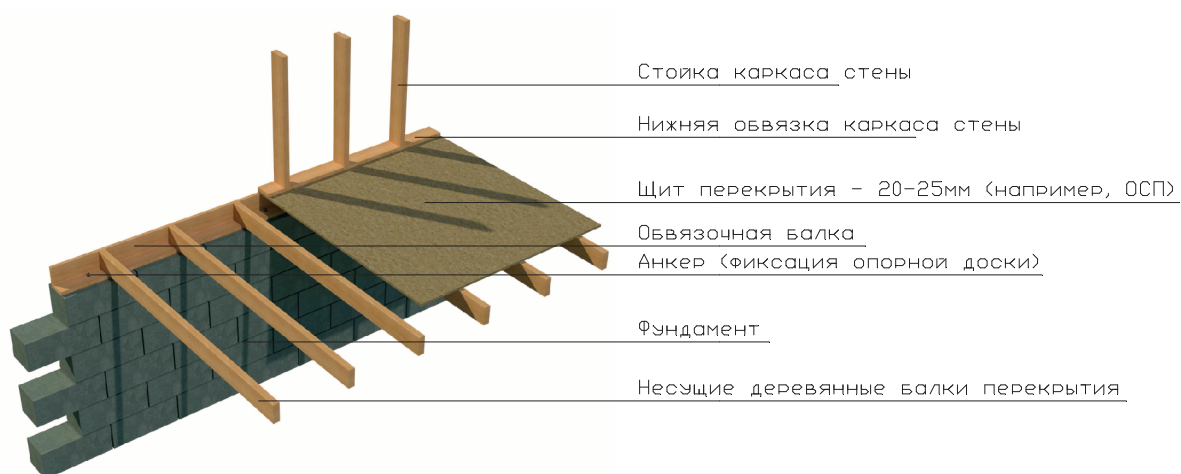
Схема примыкания к межэтажному перекрытию.
